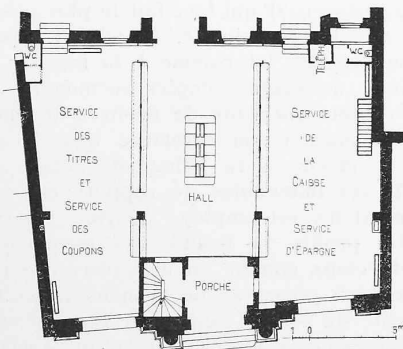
Banque cantonale à Neuchâtel. Plan du rez-de-chaussée. — Echelle 1 : 400.
